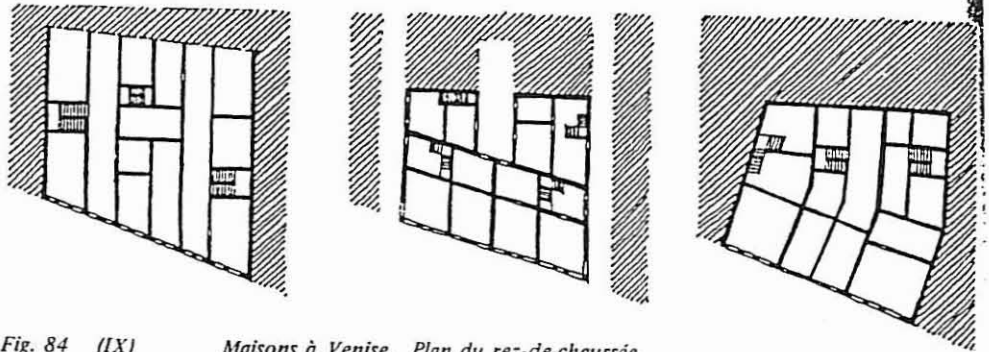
(IX) *Maisons à Venise. Plan du rez-de-chaussée.
